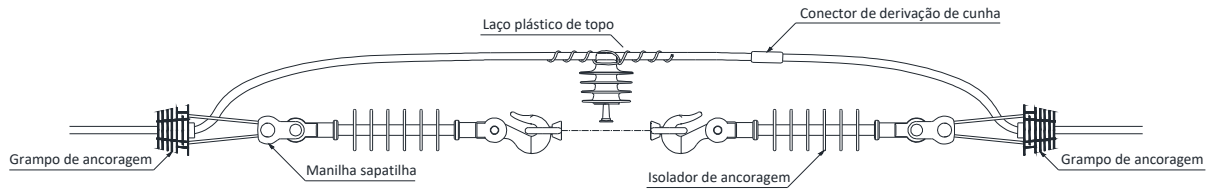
Amarrações e ligações – Ancoragem dupla – Cabo protegido
